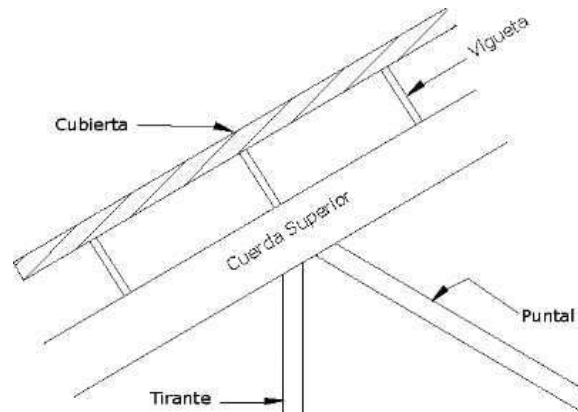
Otro ejemplo de viguetas y cubierta.
